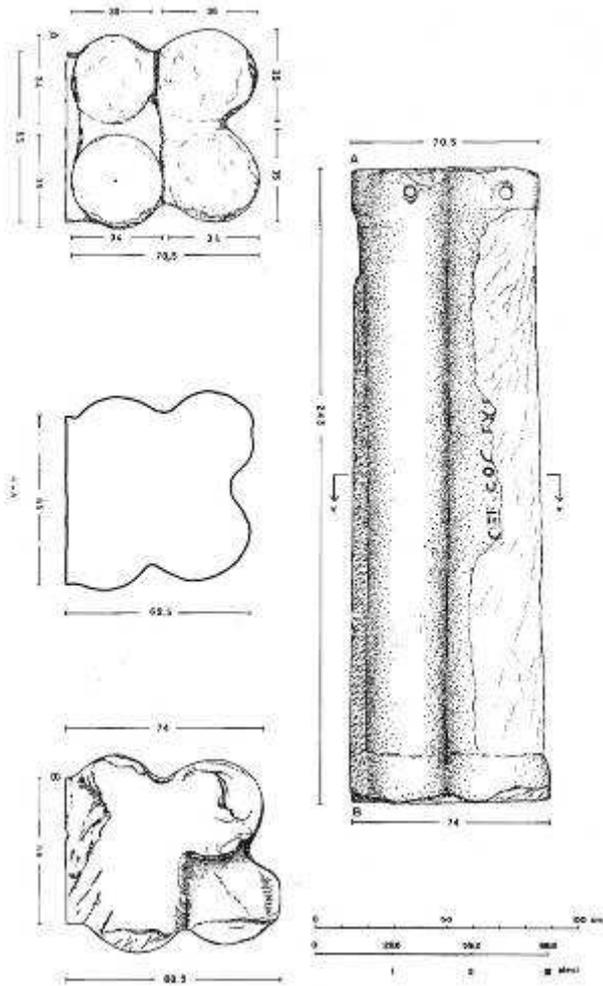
Colonna quadriloba in pavonazzetto dal fondo del Canale di Fiumicino (Roma). Pianta e prospetti (PENSABENE 1994)
